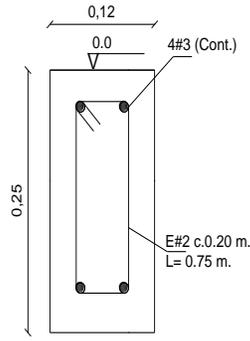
SOLADO DE PROTECCION VIGAS DE CIMENTACION
